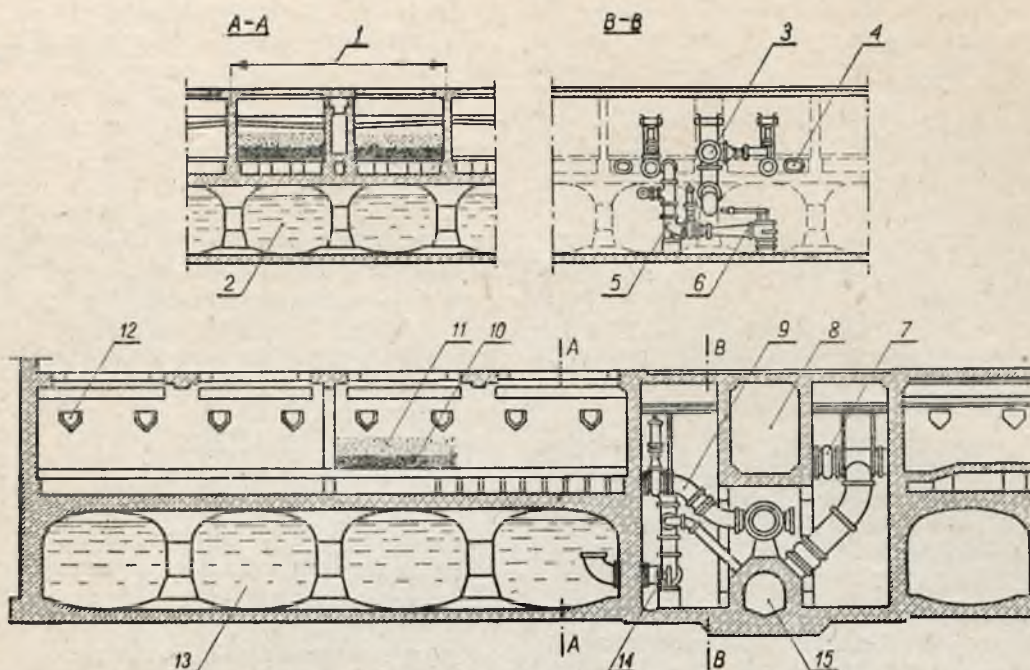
Otwarty filtr pośpieszny konstrukcji Reiser'a z układem rur powietrznych
